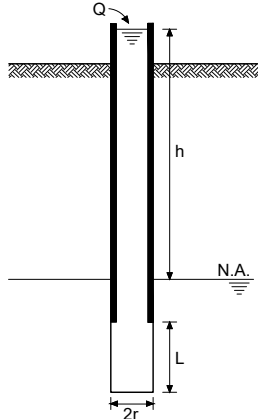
Ensaios de infiltração e rebaixamento em sondagens.
